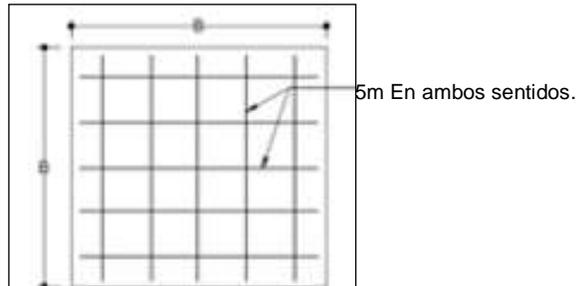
Refuerzo de acero para tapas de cajillas de inspección.
